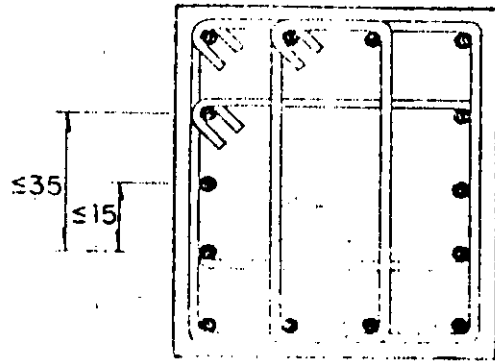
Arreglos admisibles de estribos y barras longitudinales en columnas
